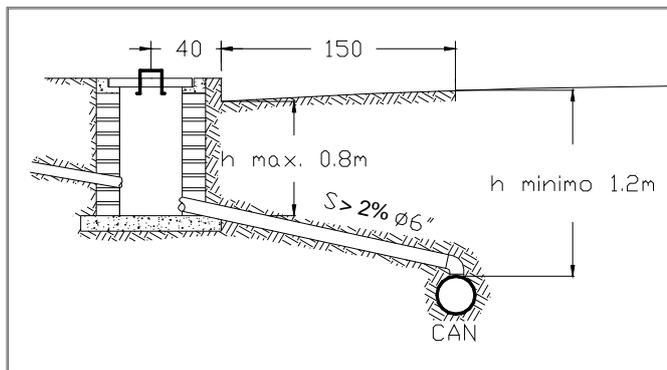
Acometida de aguas negras con caja de mampostería de ladrillo de barro
